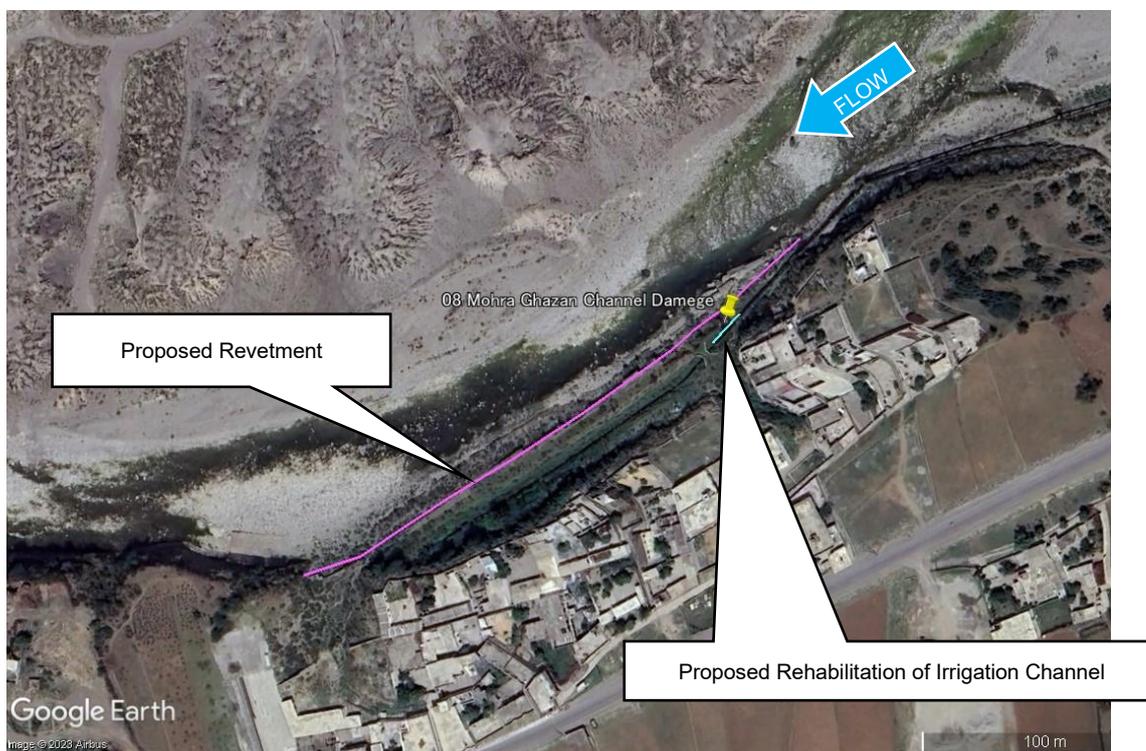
対象地点の平面図 (Mohra Ghazan)
